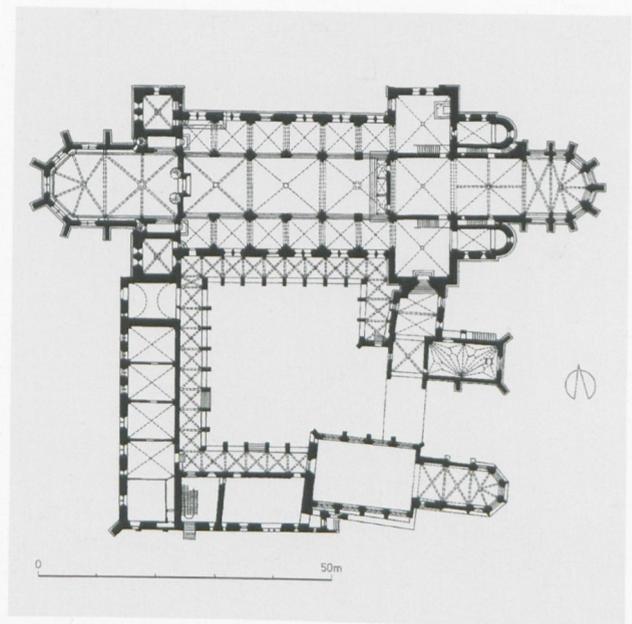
Grundriss des Naumburger Doms und der Klausur
